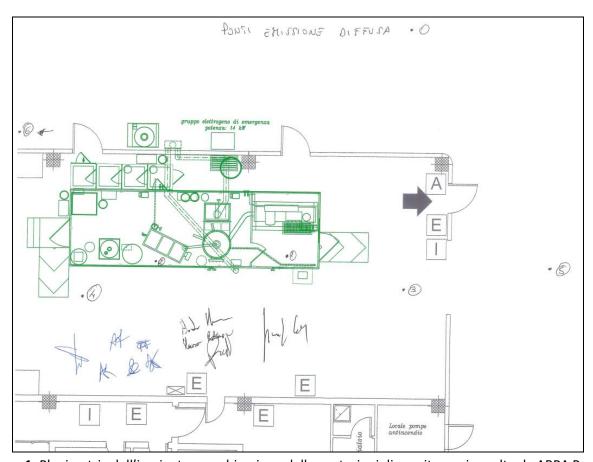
Planimetria dell'impianto con ubicazione delle postazioni di monitoraggio scelte da ARPA Puglia.
